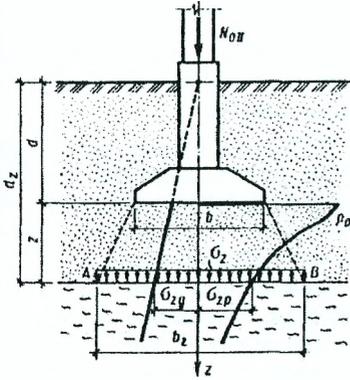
Расчетная схема к проверке давления на подстилающий слой слабого грунта
